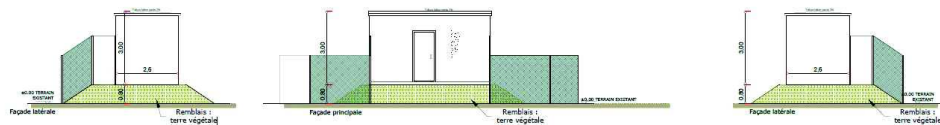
Vues des façades du poste de livraison prévu sur site
